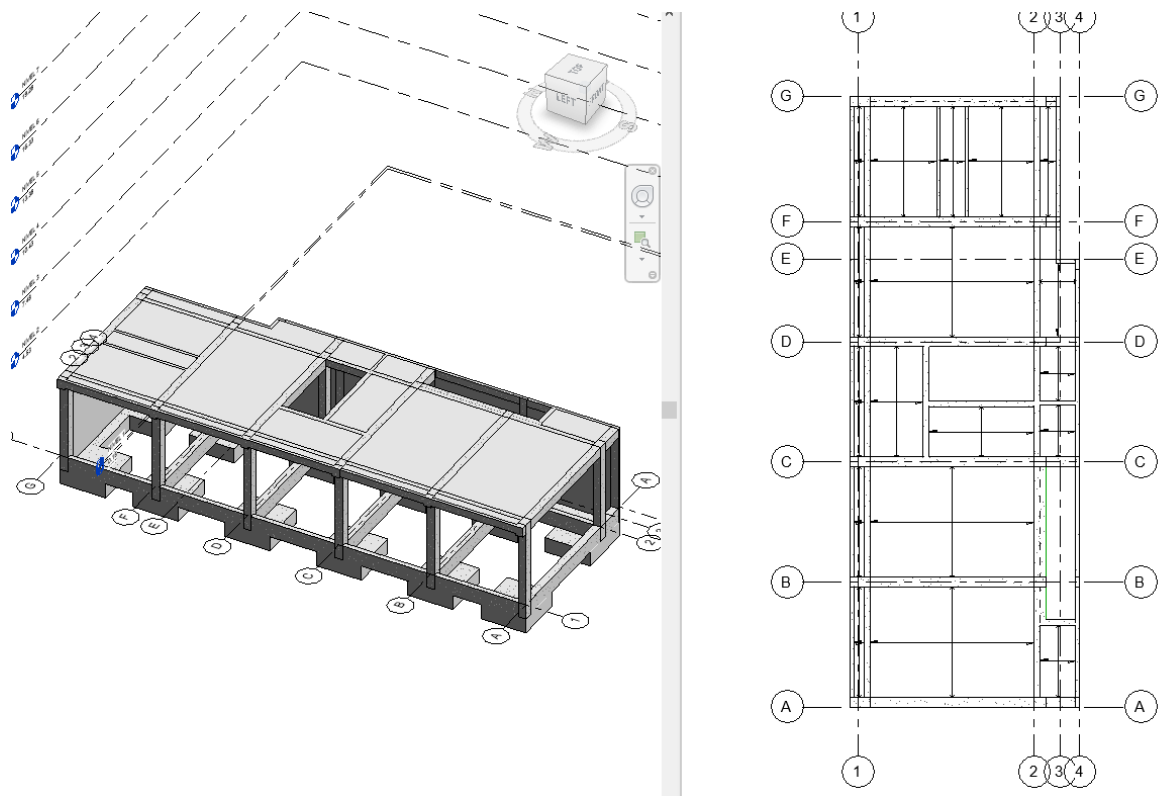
Lado izquierdo Vista 3D del modelado de Losa Aligerada del 1er nivel y al lado derecho su planta (Fuente: Elaboración Propia).
